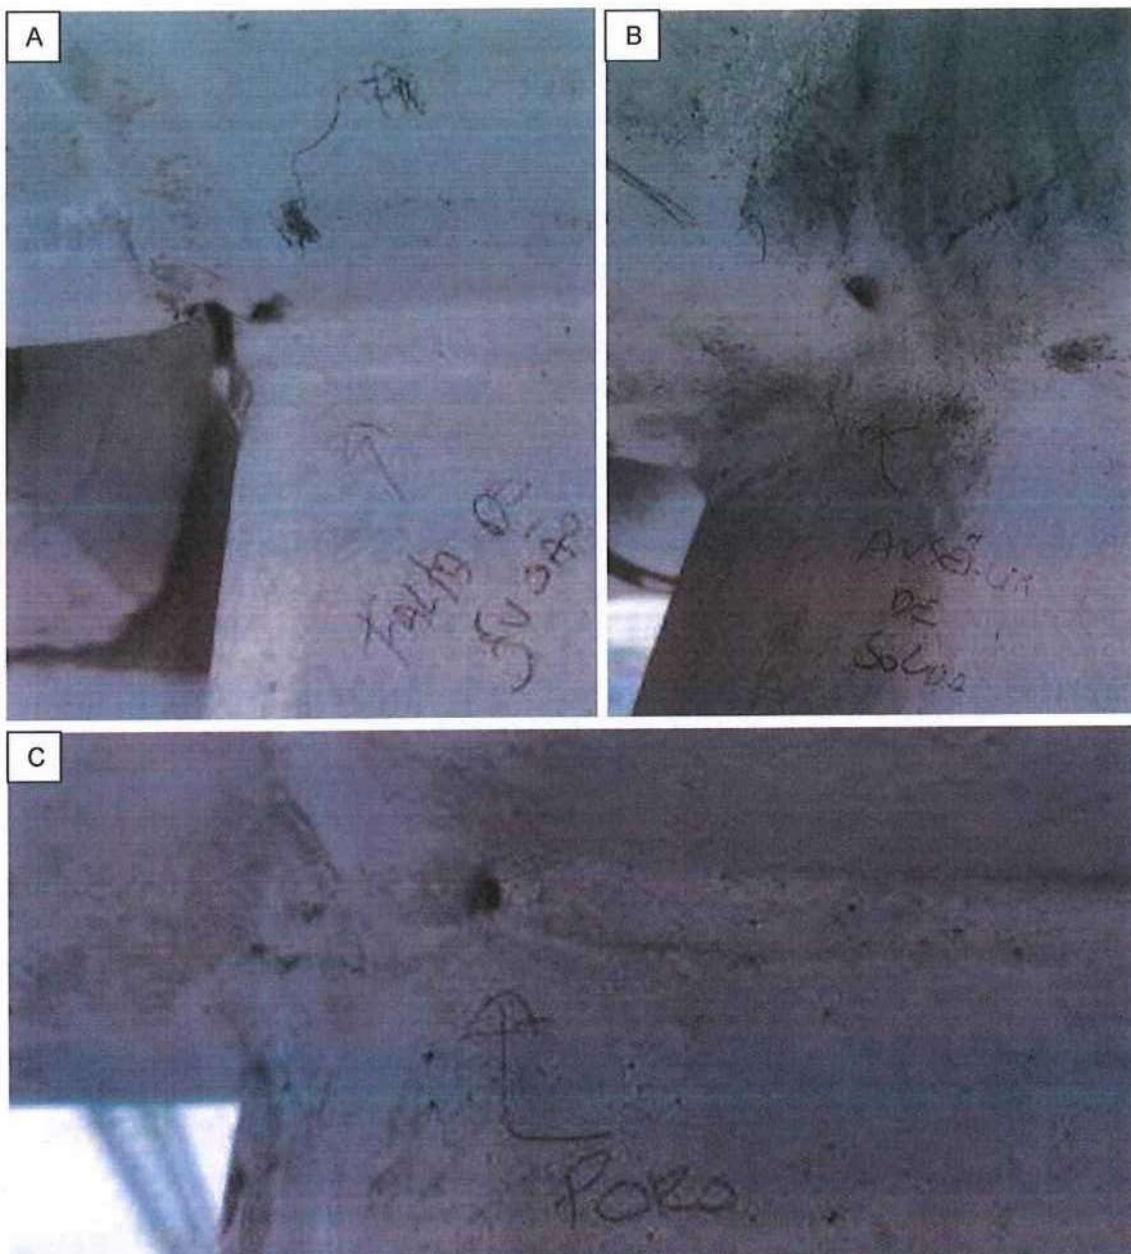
(A) Falta de fusão na junta soldada; (B) Região não soldada; (C) Porosidade na junta soldada
